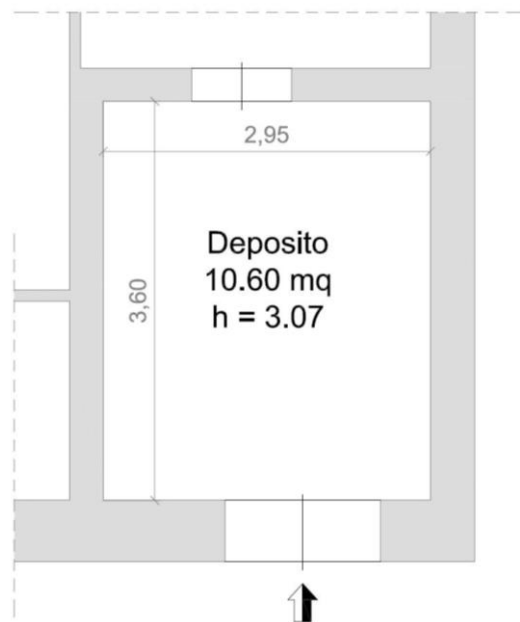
Planimetria Catastale Foglio 46, p.lla 1235, sub 21.
